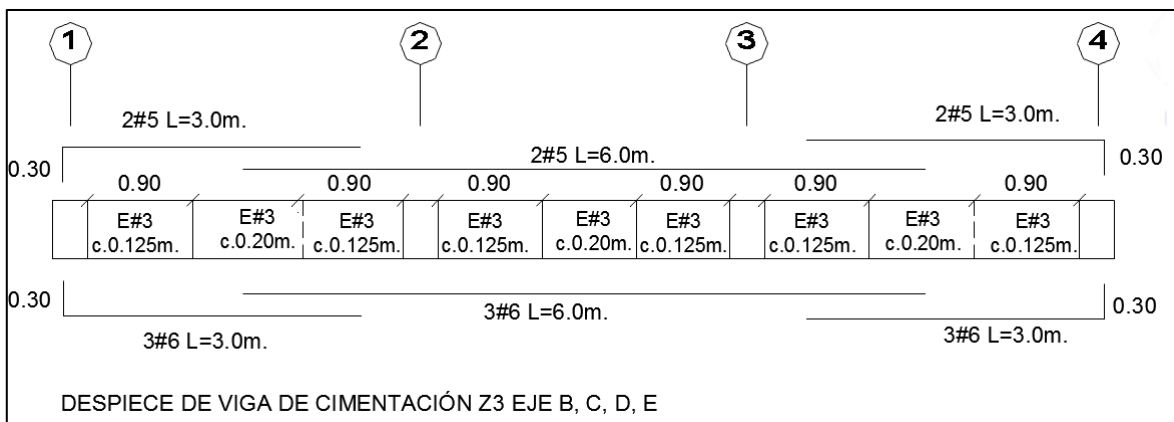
Figura XIII Despiece de viga de cimentación de zapata Z3 eje B, C, D, E.
